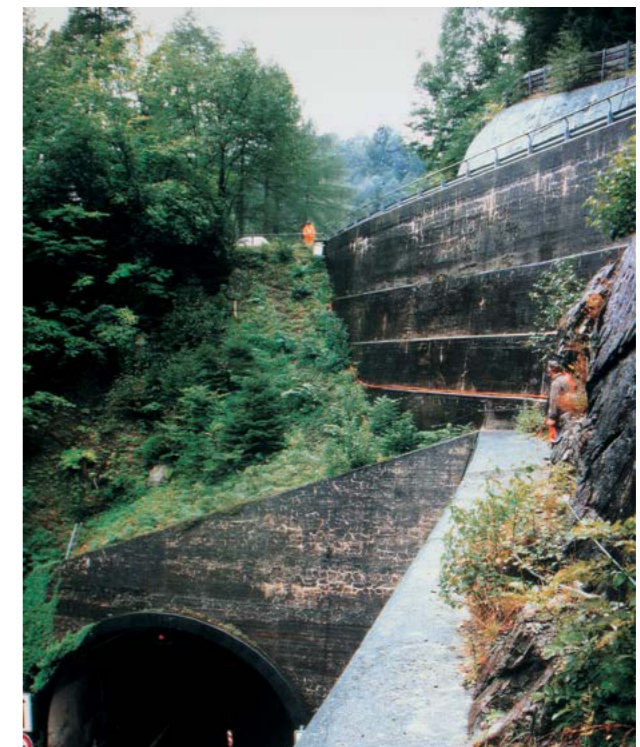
Starke AKR-Schäden an einem Tunnelgewölbe
